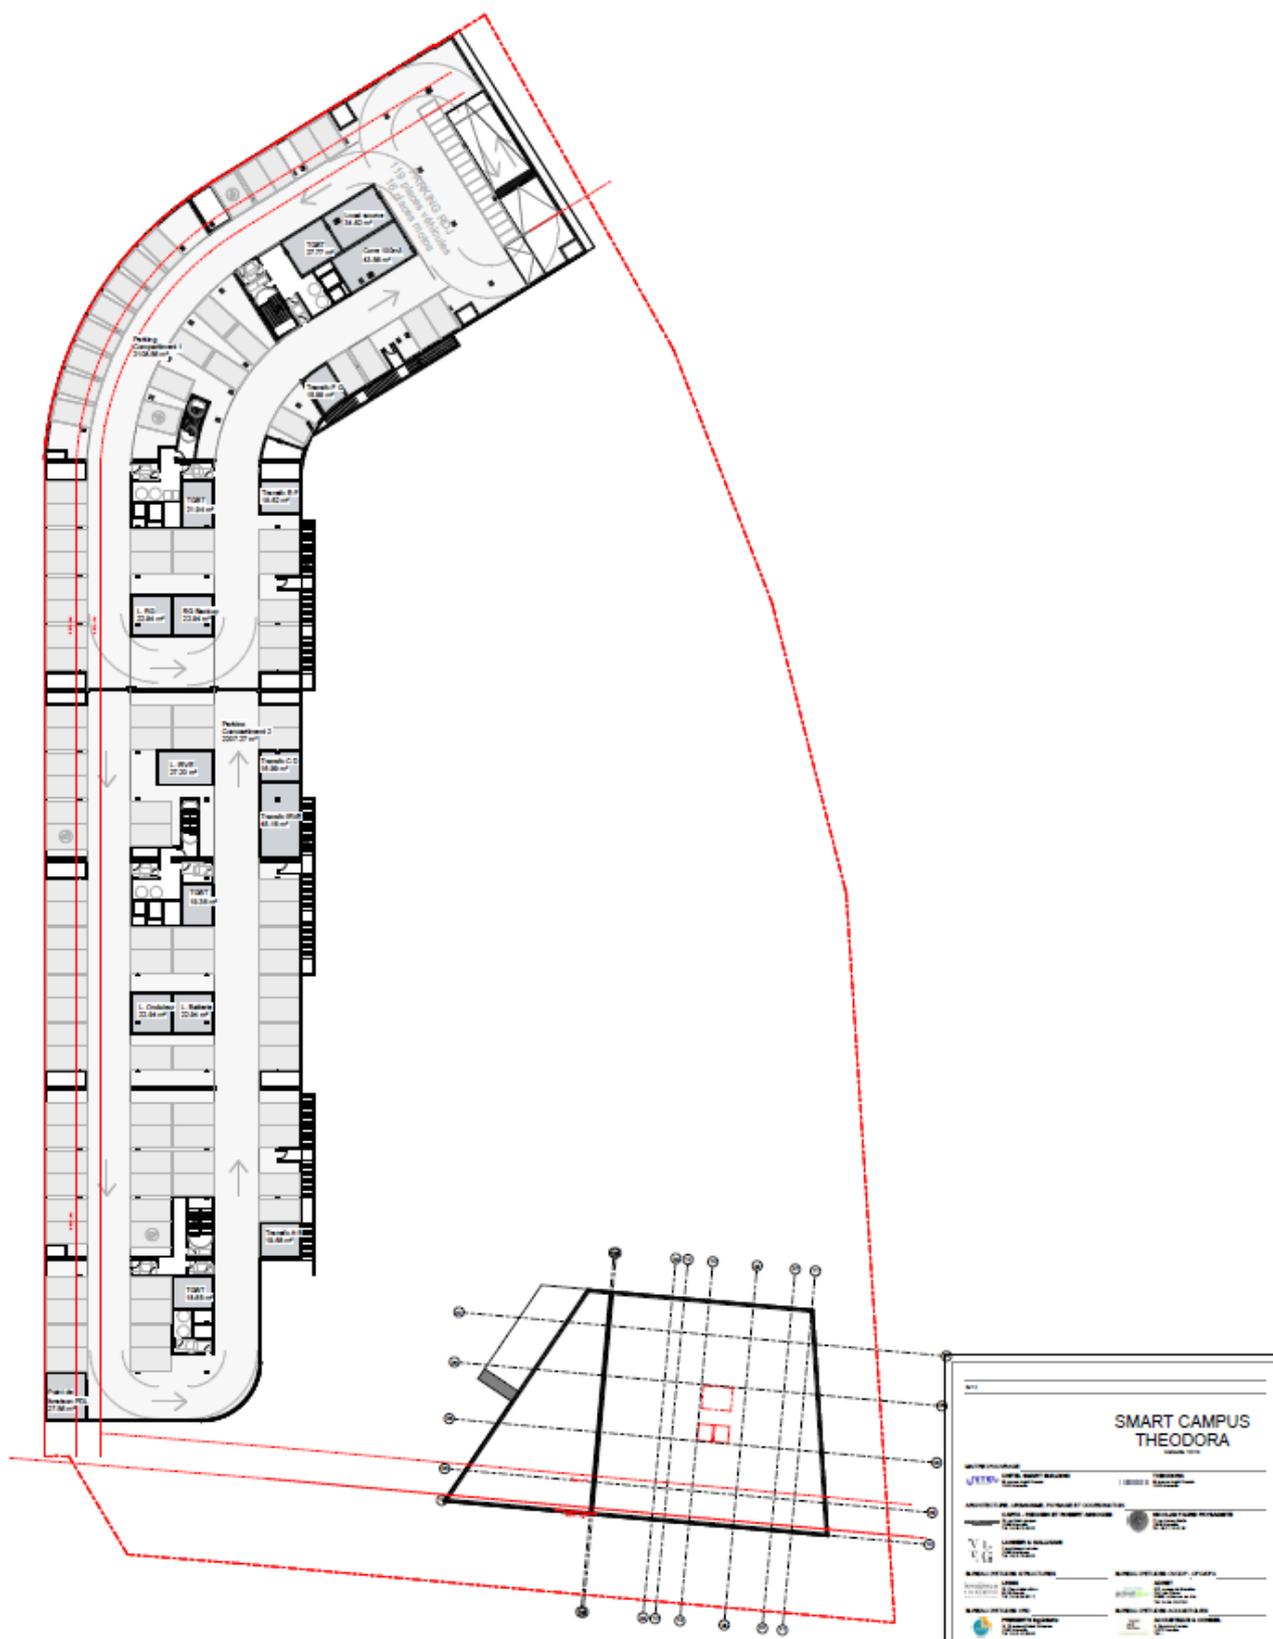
Plan de masse des bâtiments - niveau sous-sol n°1 (octobre 2023)
